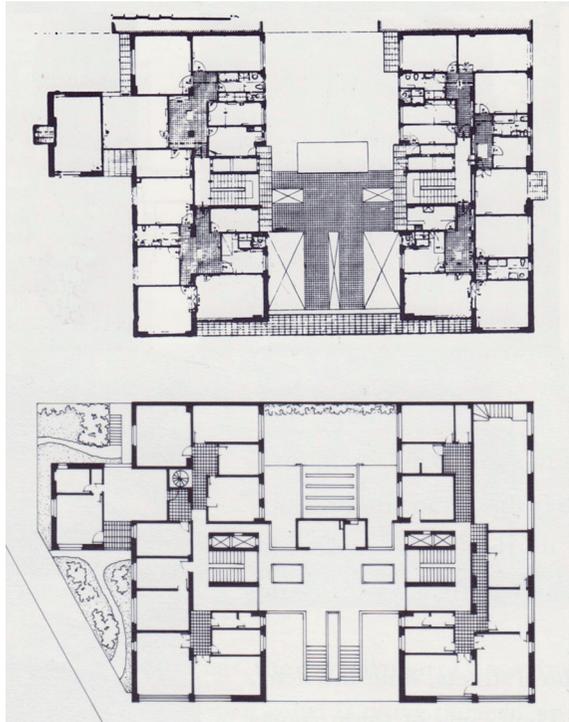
Haus Rustici, Grundrisse: Eingangsgeschoss, 1. Obergeschoss
